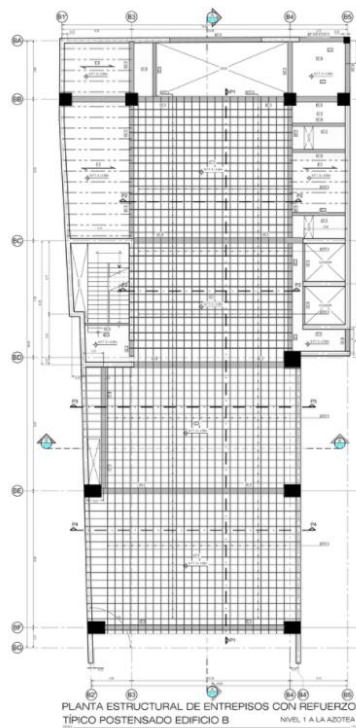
Planta de entrepiso postensado proyecto JUPEMA
